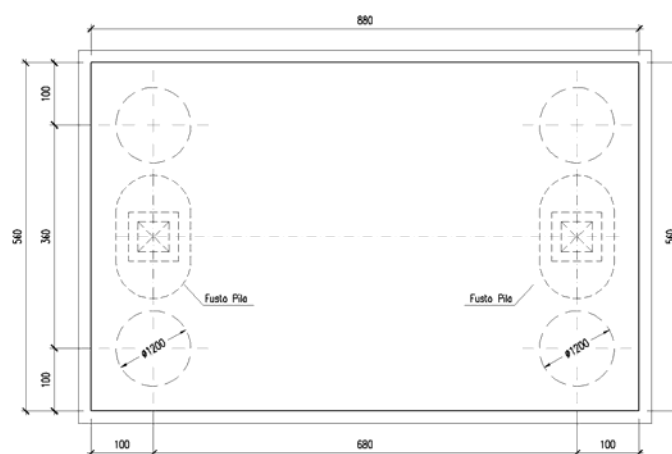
Carpenteria fondazioni delle pile 1 e 3
